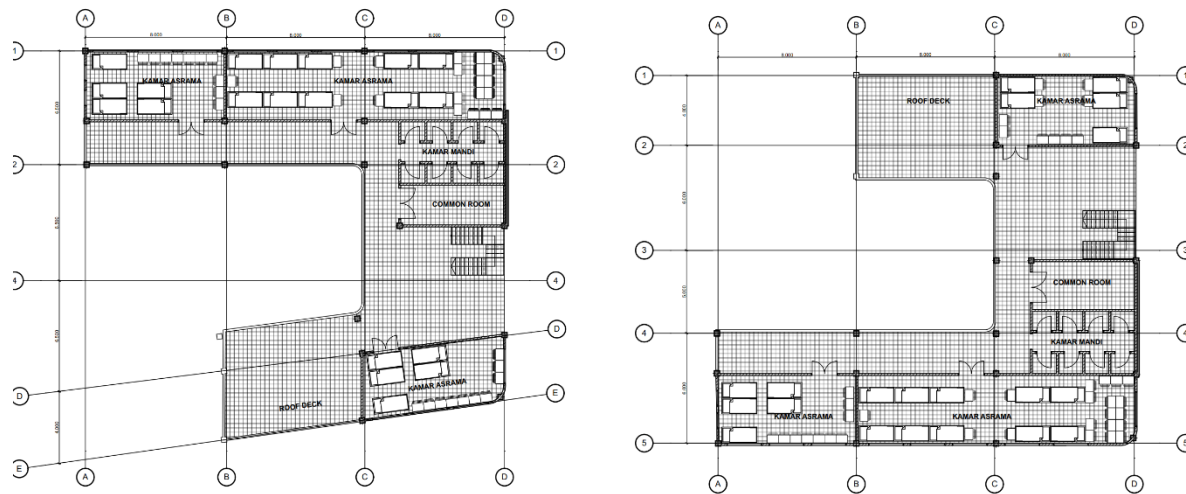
Denah Asrama Lantai 1 Setelah Evaluasi
